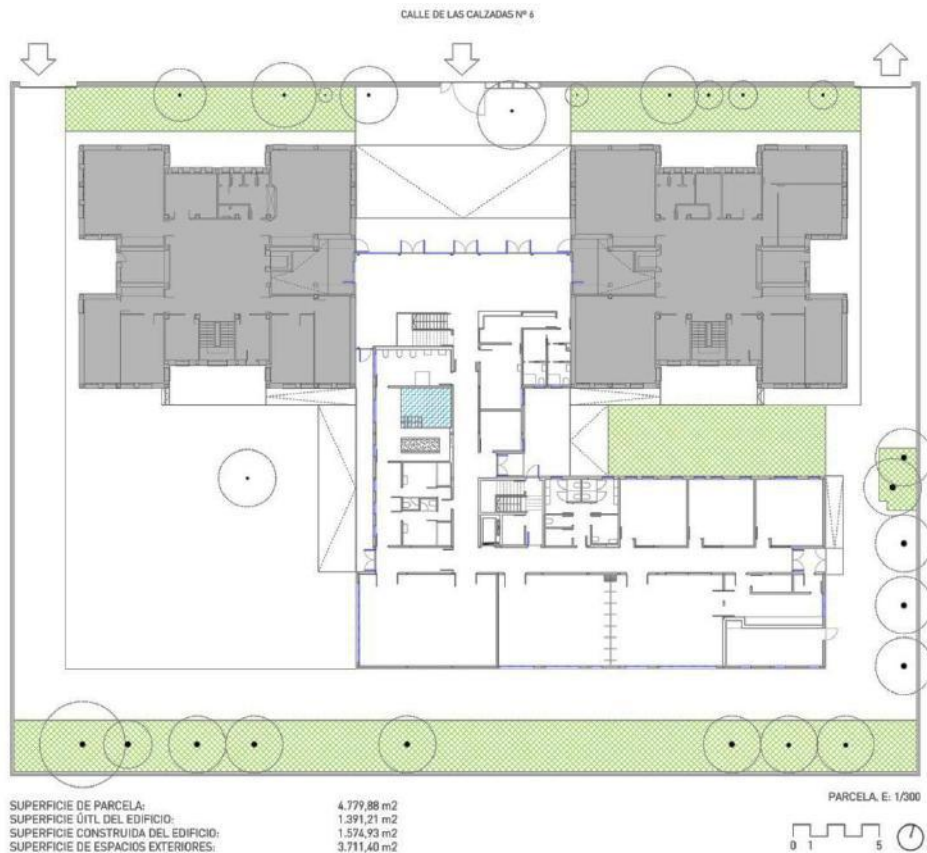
Planta de Conjunto (Fuente:ArchDaily S/E)
